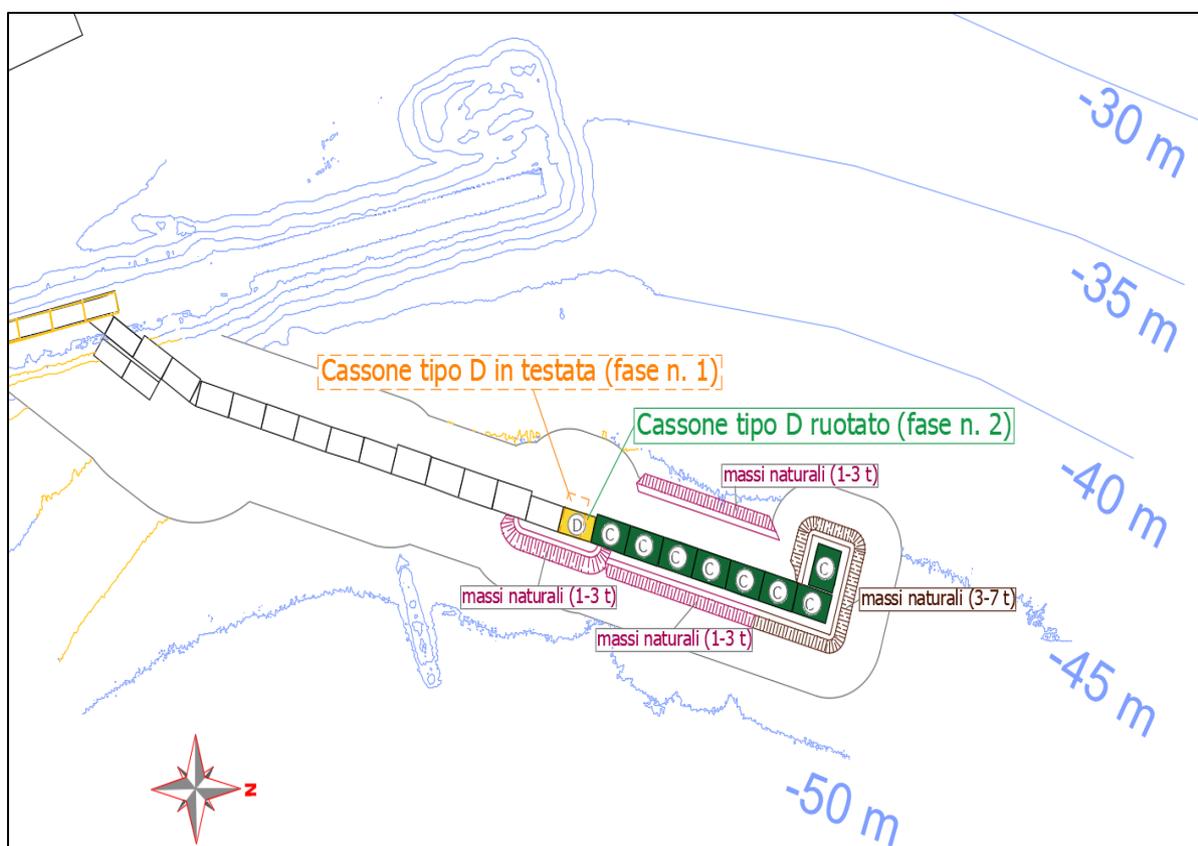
Schema assetto planimetrico tipologie di cassoni C e D, completo dell'indicazione delle scogliere di protezione dello scanno d'imbasamento (fase n. 2)
